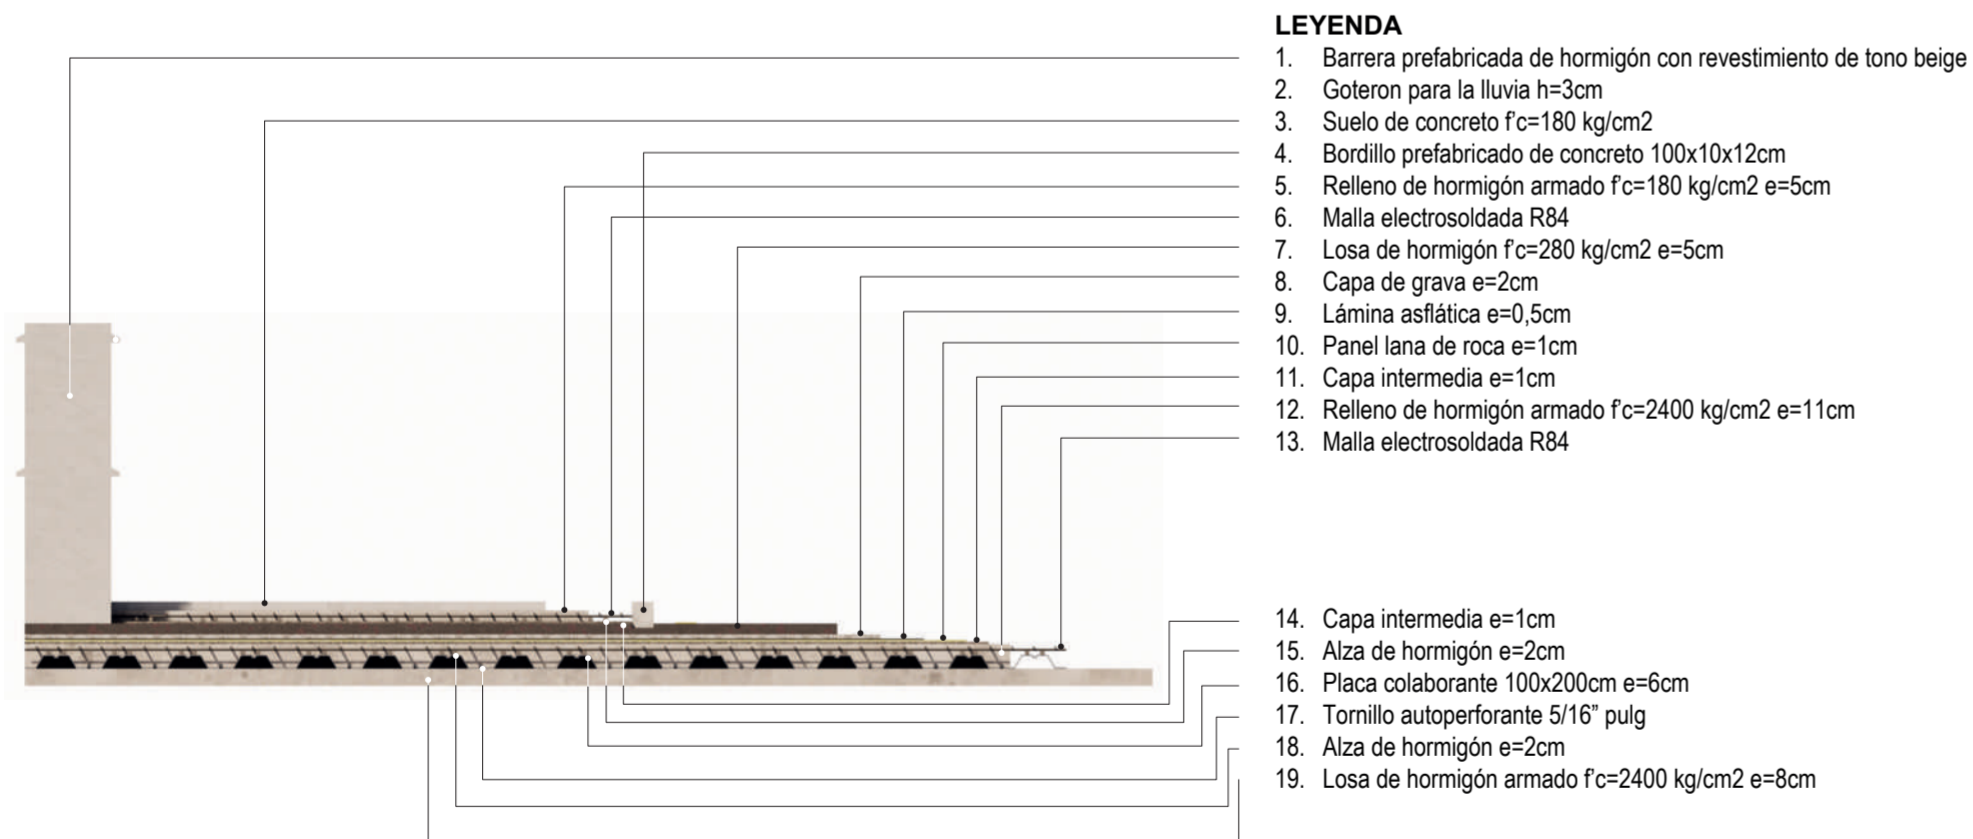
Detalle realista en elevación del sistema constructivo de barrera - andén - calzada. Fuente y elaboración: Propia.
